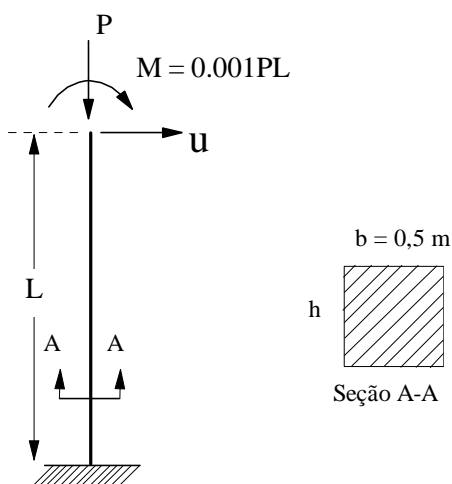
Pilar engastado-livre e detalhe da sua seção transversal
